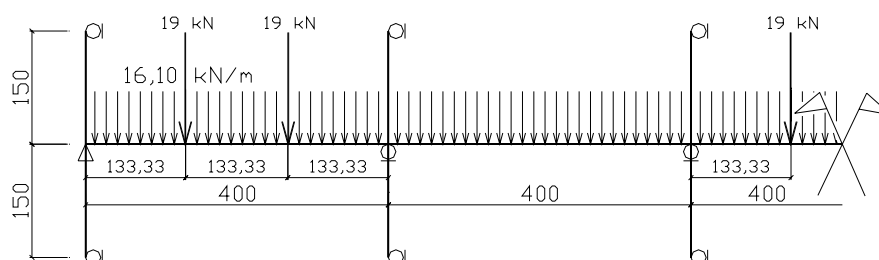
Esquema estrutural e de carregamento, Caso 7 (dimensões em cm)
